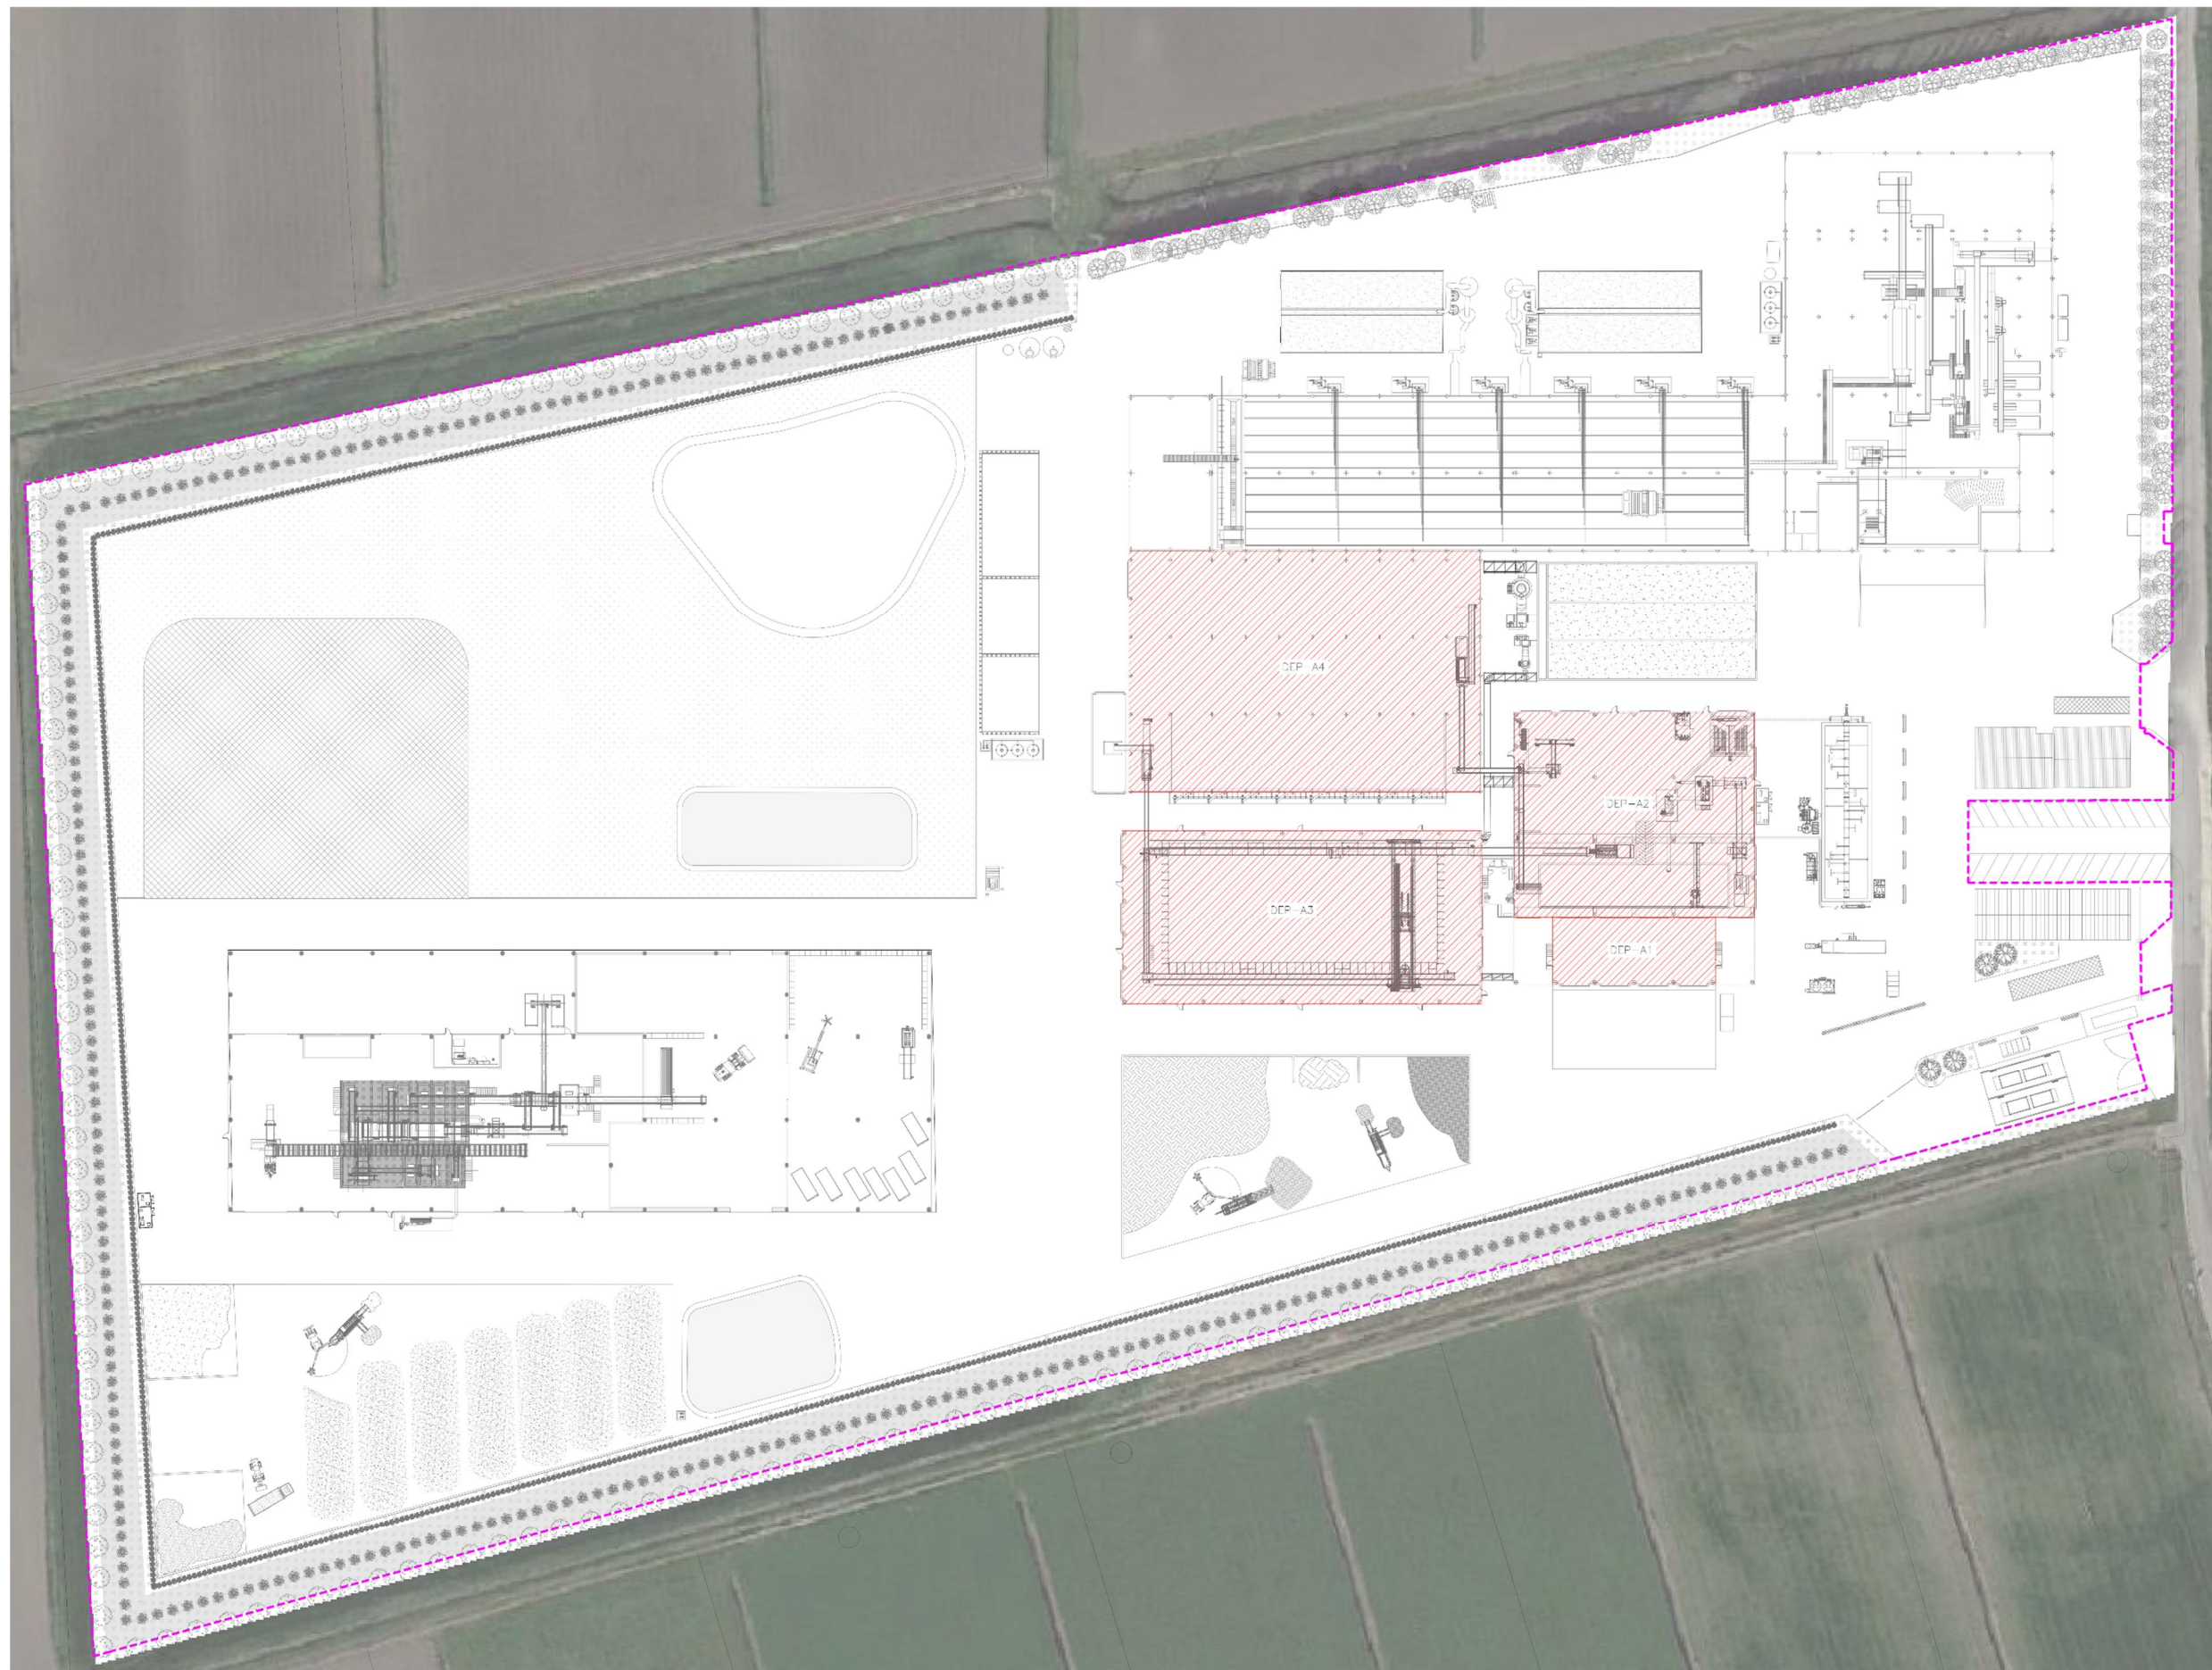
Planimetria ISTALLAZIONE Monitoraggio depressione
